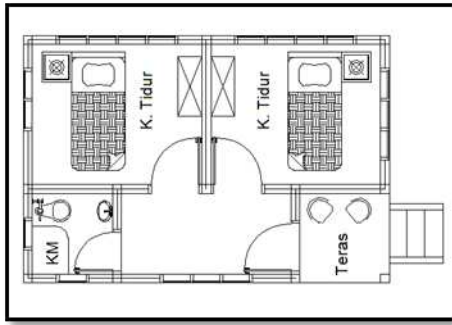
Denah *Cottage Tipe Anggrek
